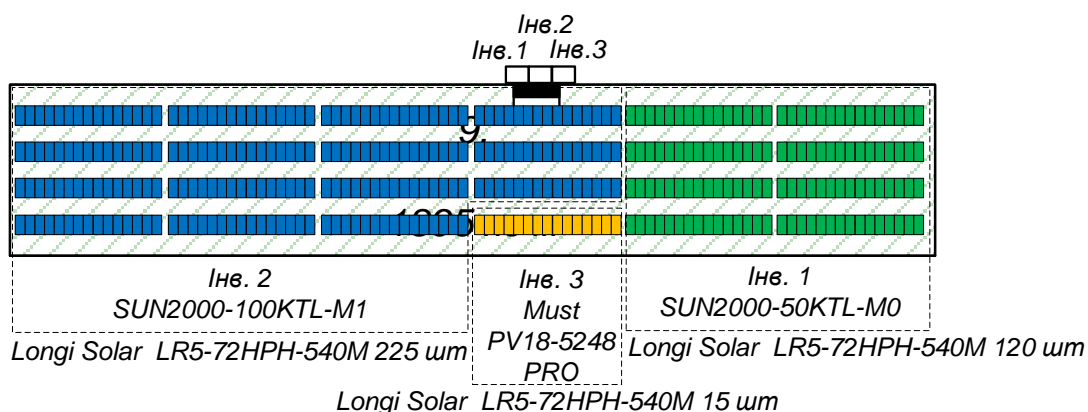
Розташування фотомодулів та інверторного обладнання
